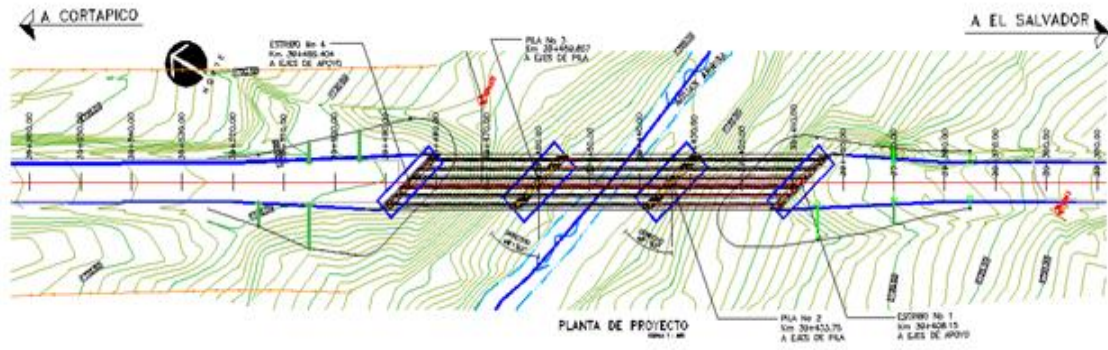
Plano y diseño maestro del puente Jilasco.
